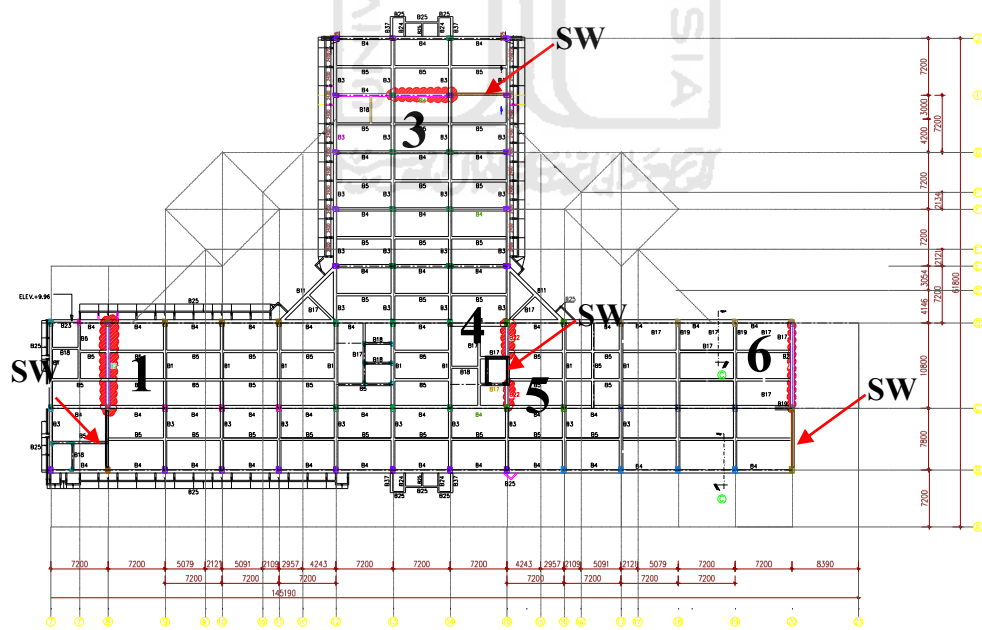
28 Balok yang Berpotensi Menjadi Elemen Kolektor pada Lantai 1
